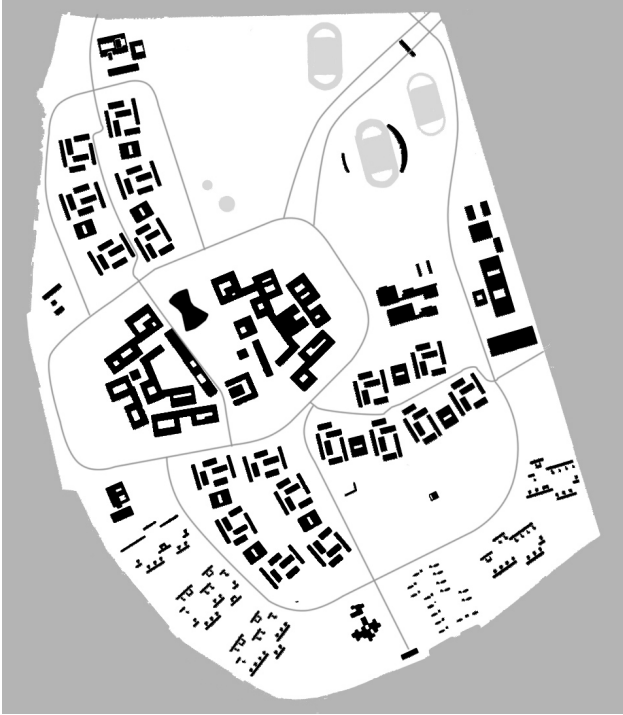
Plan schematic al Campusului Universitar/ Schematic representation of the site plan proposed for the Baghdad University Campus.
